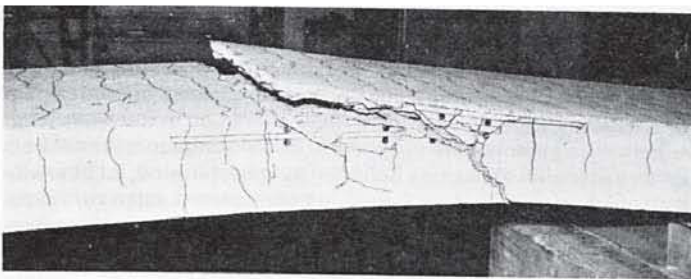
Bruchbild eines Übergreifungsstoßes geschweißter Betonstahlmatten (Zwei-Ebenen-Stoß ohne Umschließungsbewehrung (nach [29]))
